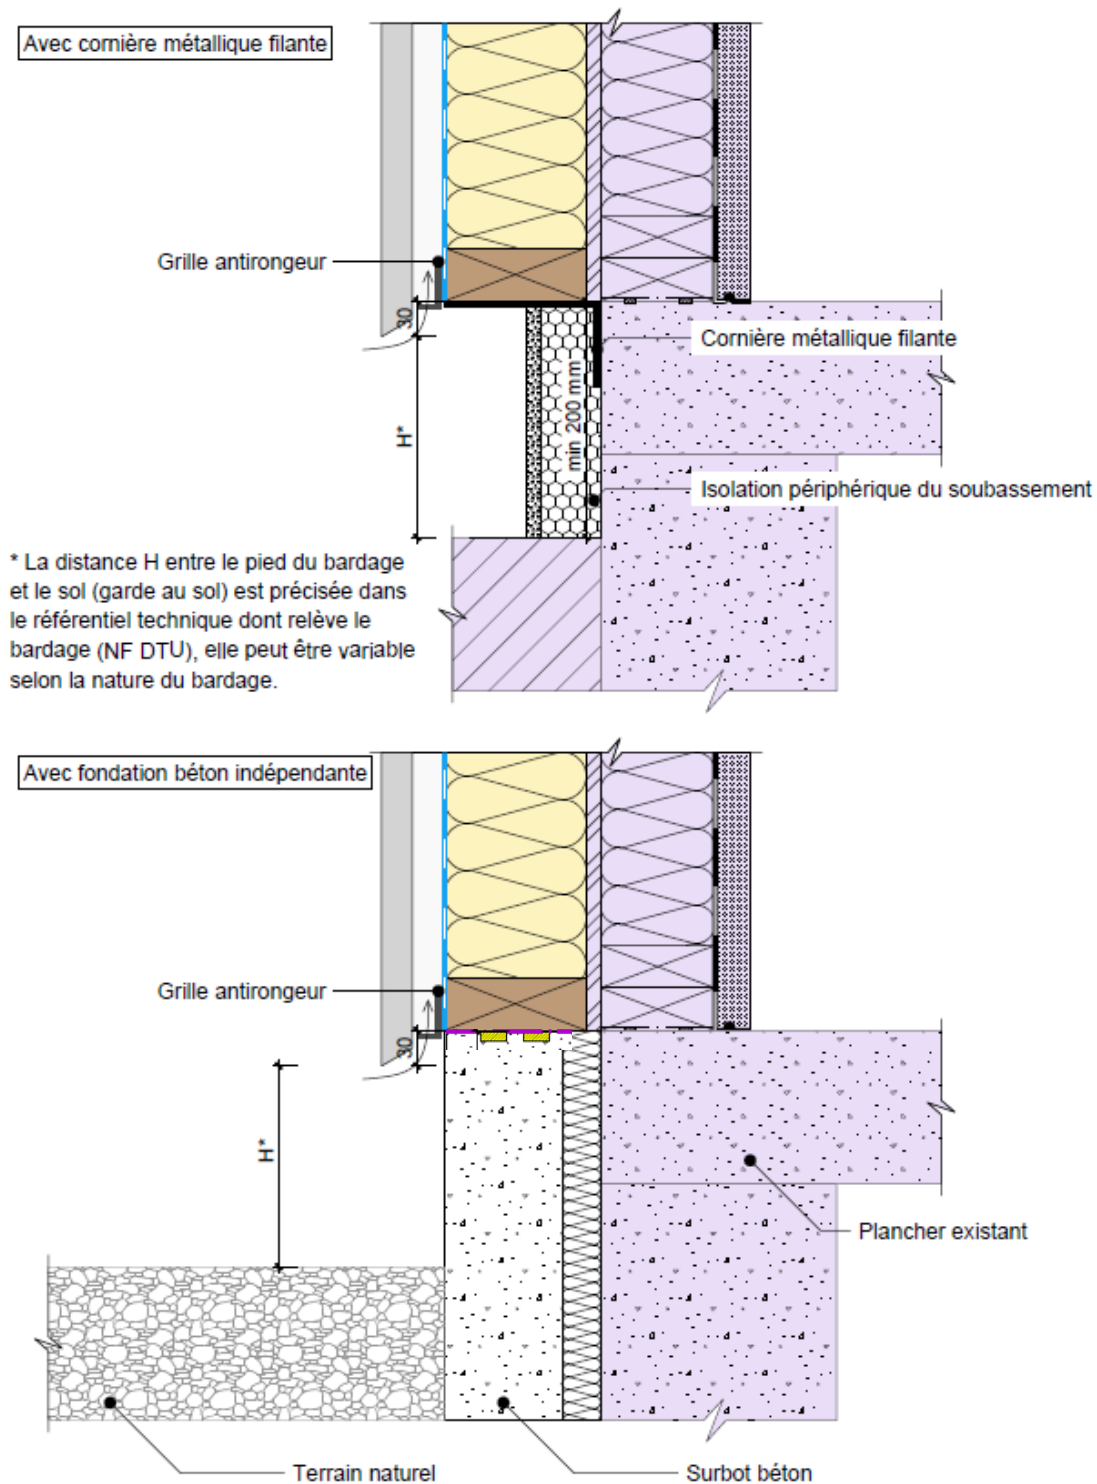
Pied de mur – reprise des charges verticales par cornière (en haut) ou par fondation rapportée (en bas) (coupe verticale)
